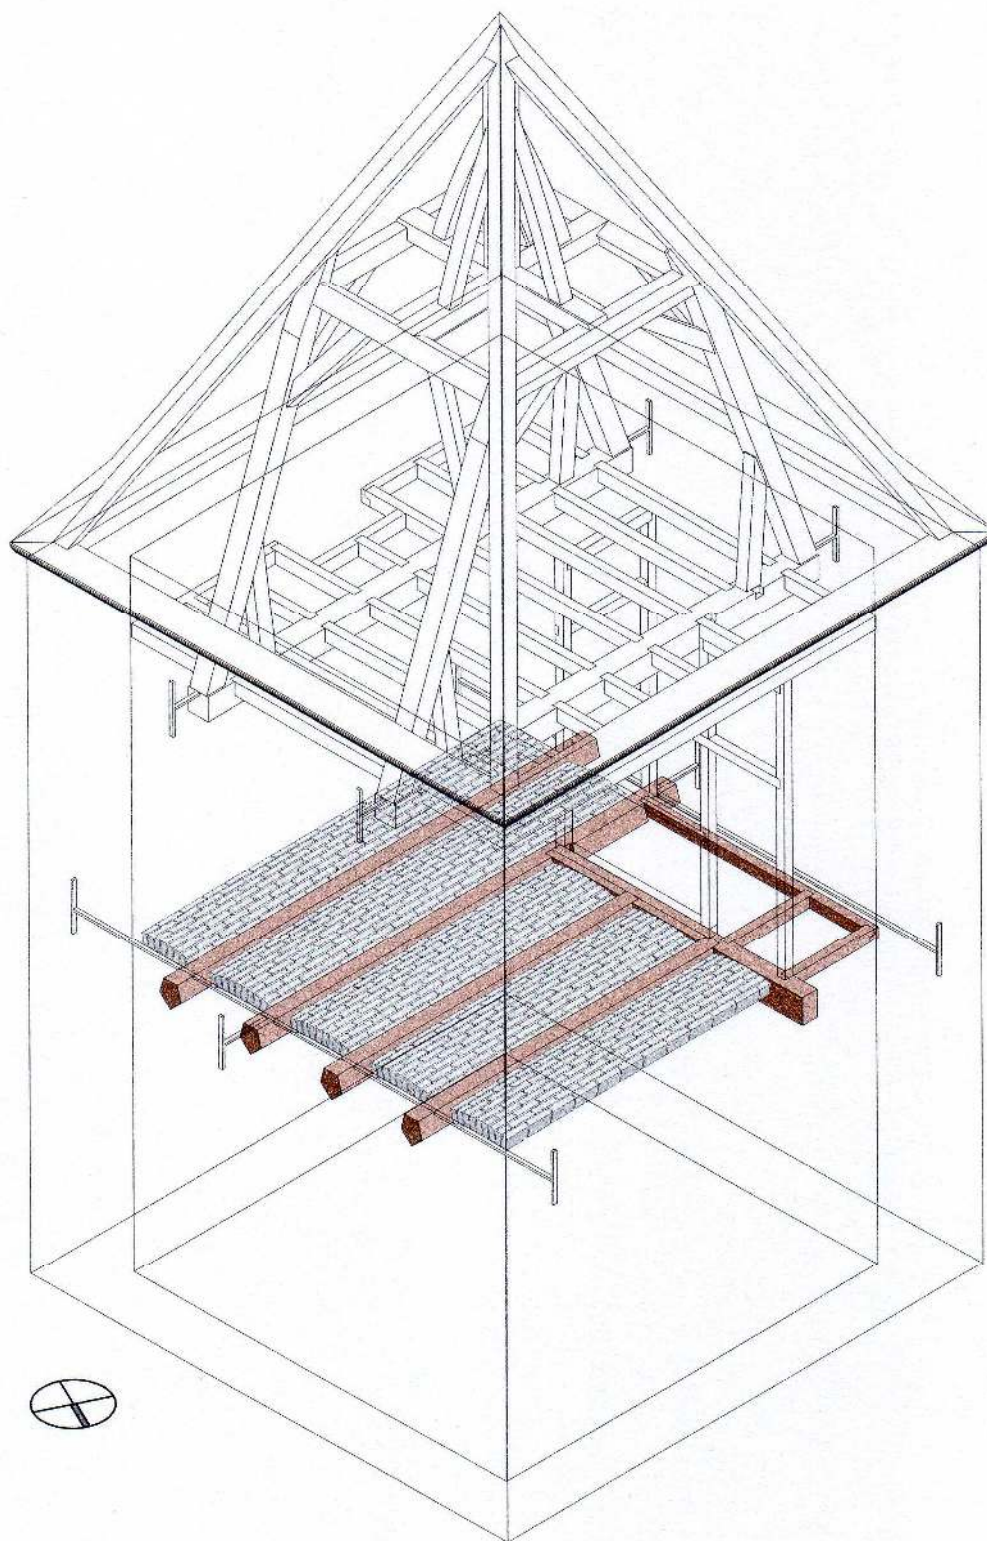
Vue en perspective. Plancher à entrevous en briques et solives sur pointe. Hors échelle. IG 2008.
